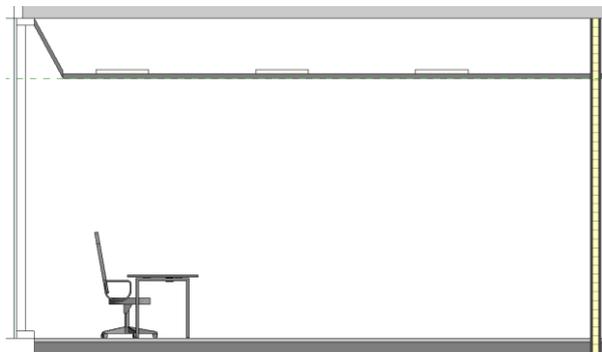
Sezione di un ufficio con apparecchi di illuminazione su piano di riferimento
